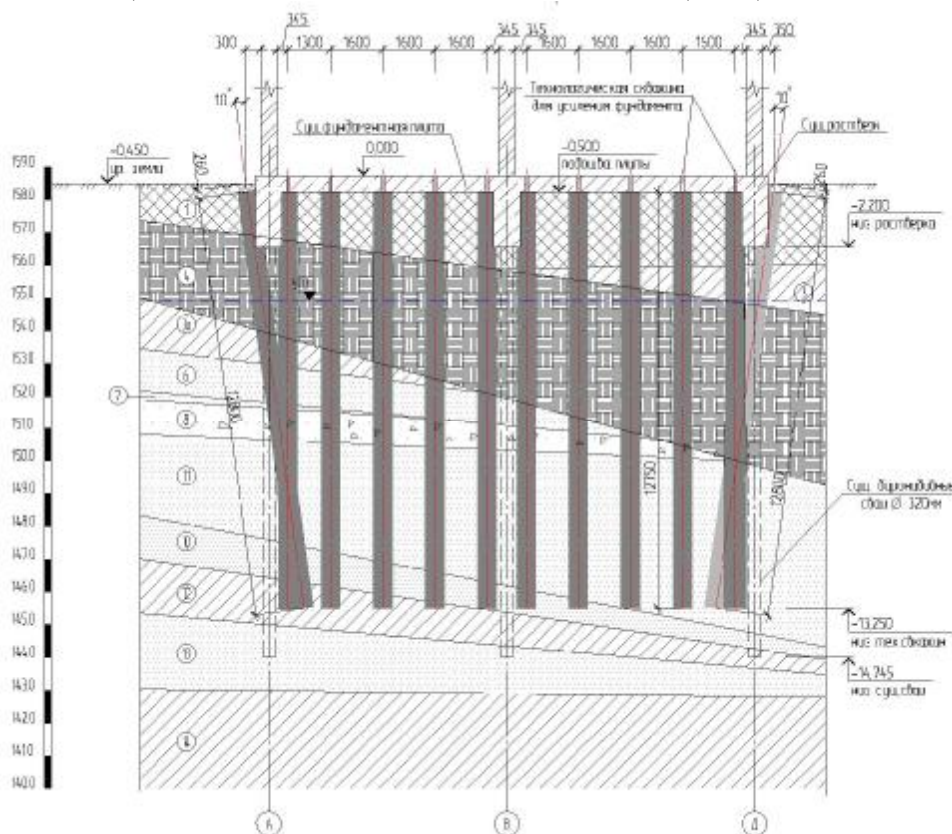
Разрез грунтового основания усиленного грунтоцементными элементами
